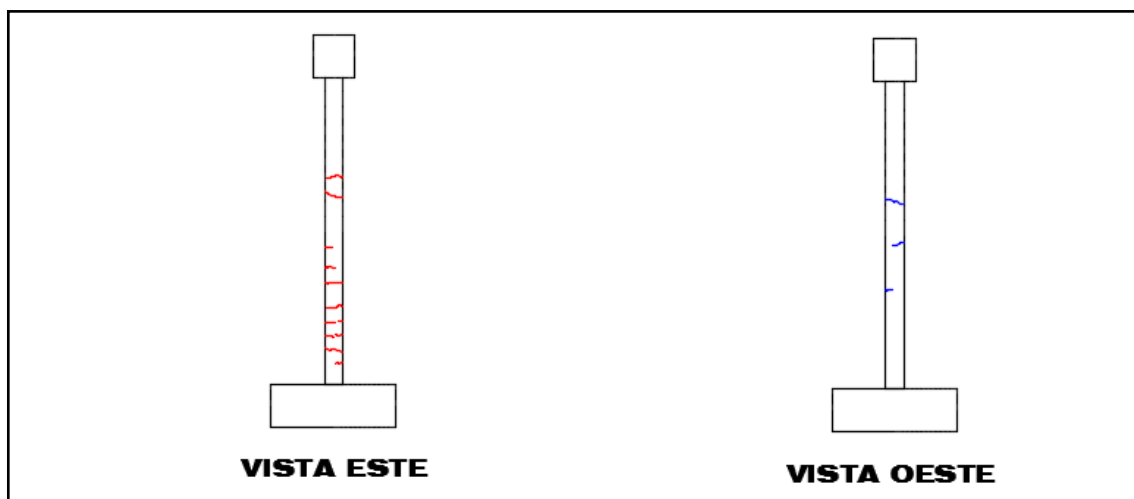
Mapeo de fisuras en elementos de confinamiento para una distorsión de 1/550.
